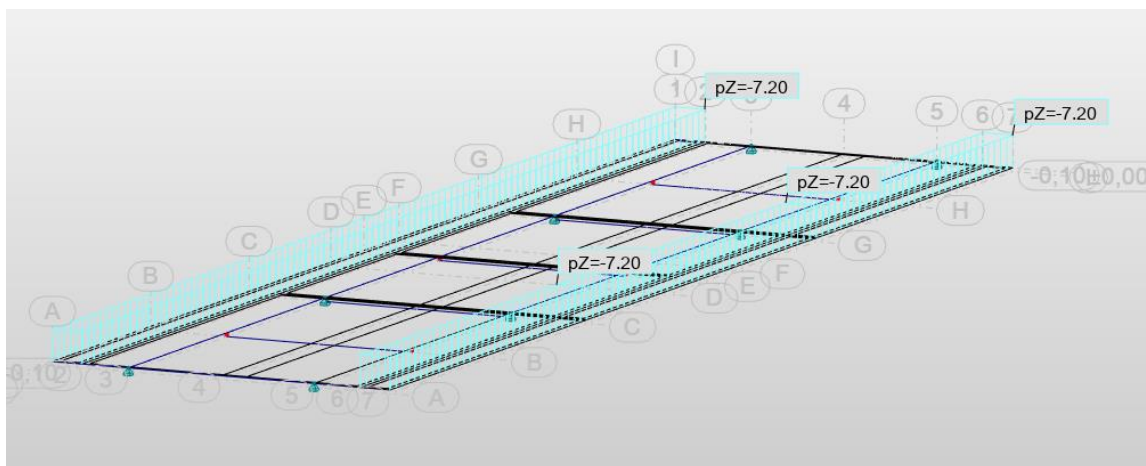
Carregamento referente ao pavimento no modelo MEF (em kN/m^2) da ponte 1
